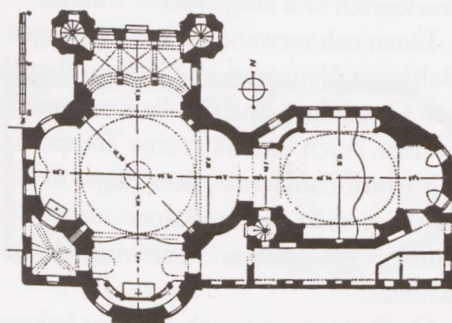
Würzburg, Kappelle, Wallfahrtskirche
